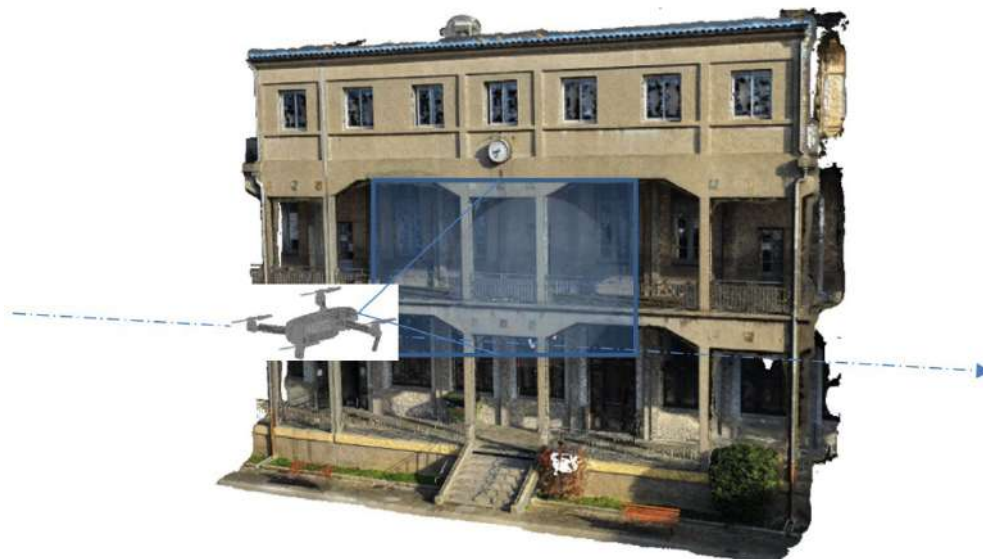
imágenes de un edificio para fotogrametría de fachada
